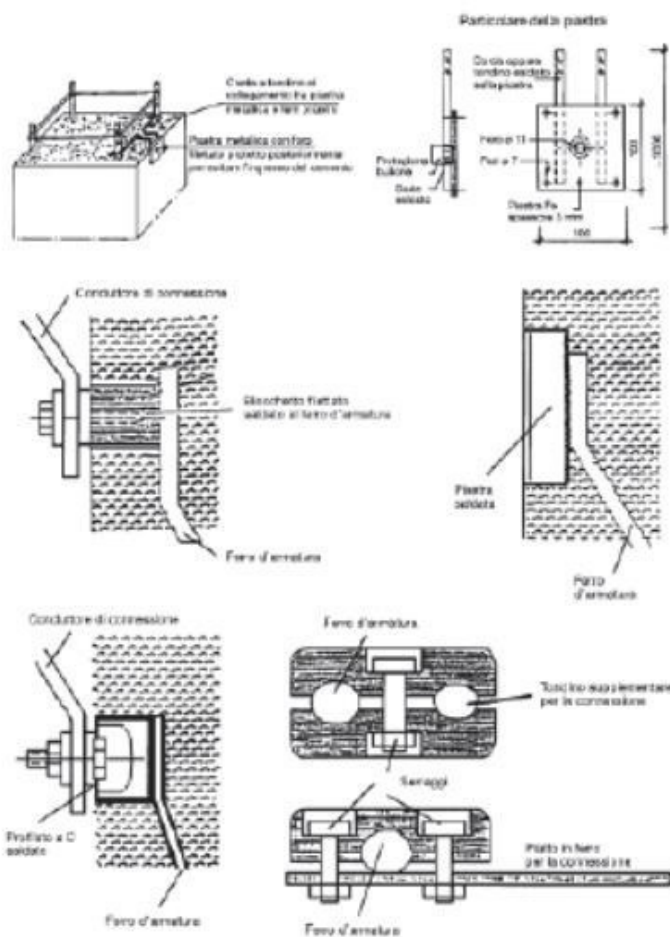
Esempi di collegamento ai ferri del pilastro o del plinto con piastra metallica (o con altri elementi metallici) incorporata nel getto del calcestruzzo
